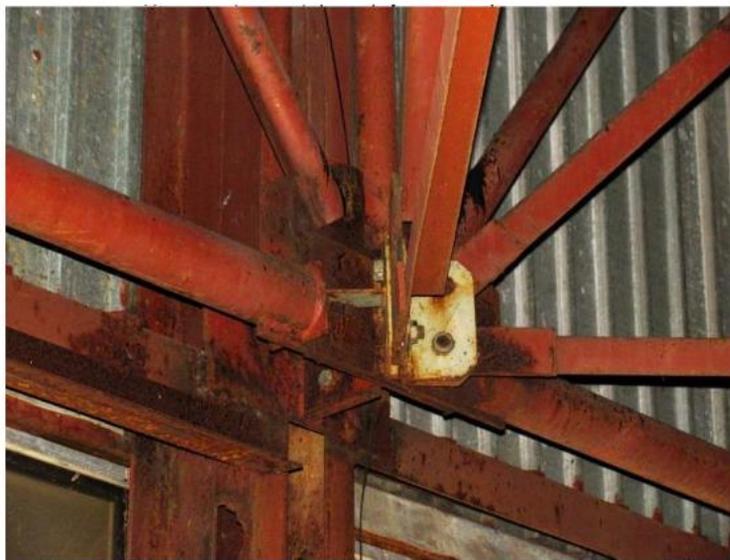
Бокове кріплення до стійки фахверку просторової конструкції перекриття.
